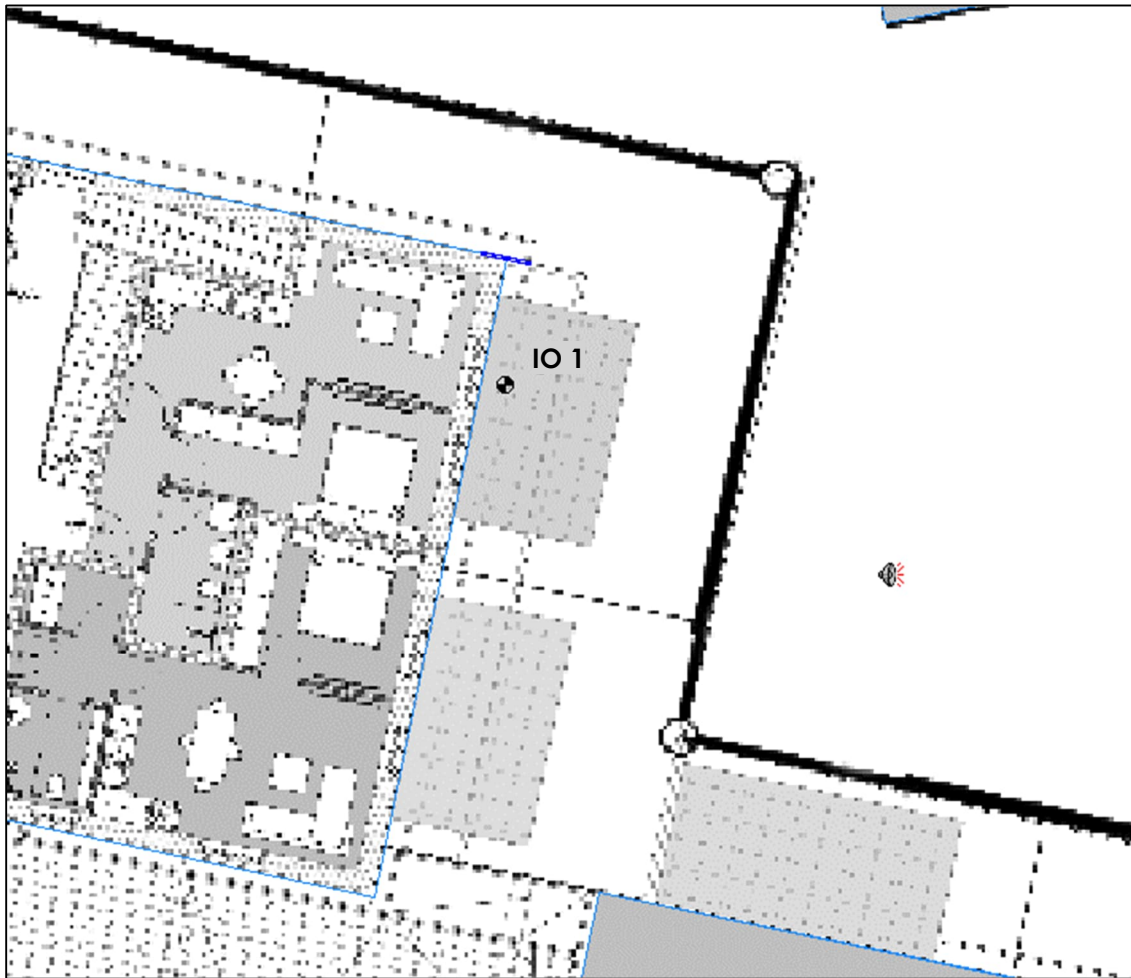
Lageplan mit Darstellung des betrachteten Immissionsorts
